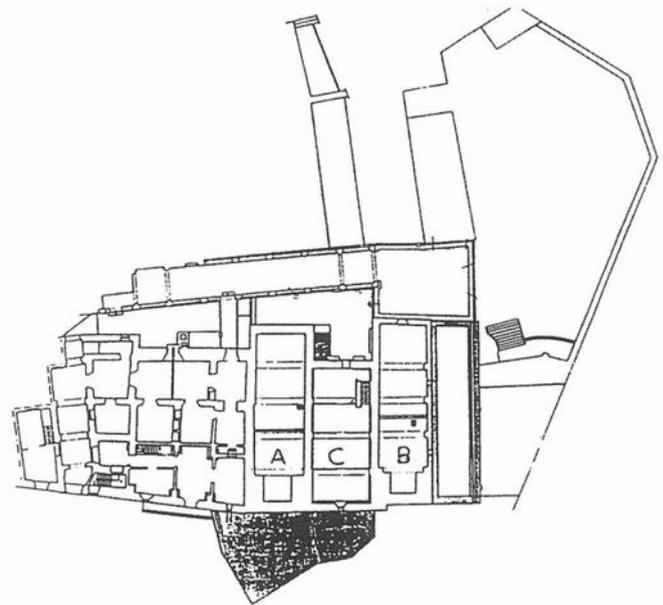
Planta del edificio y ubicación de las naves excavadas.
